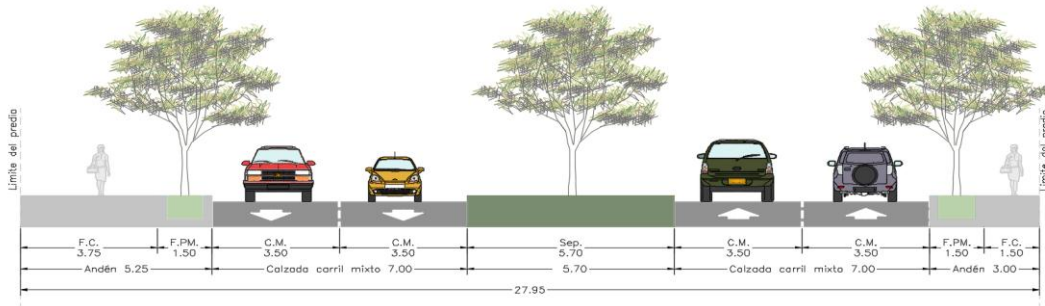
Sección Típica sobre la Calle 8 Sur entre la Autopista Sur y la KR 27
